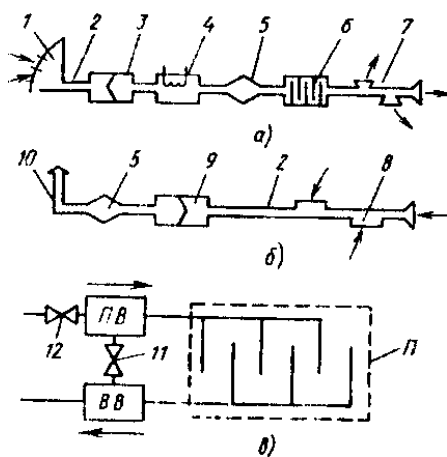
Схемы общеобменной вентиляции: а – приточная вентиляция; б – вытяжная вентиляция; в – приточно-вытяжная вентиляция с рециркуляцией
